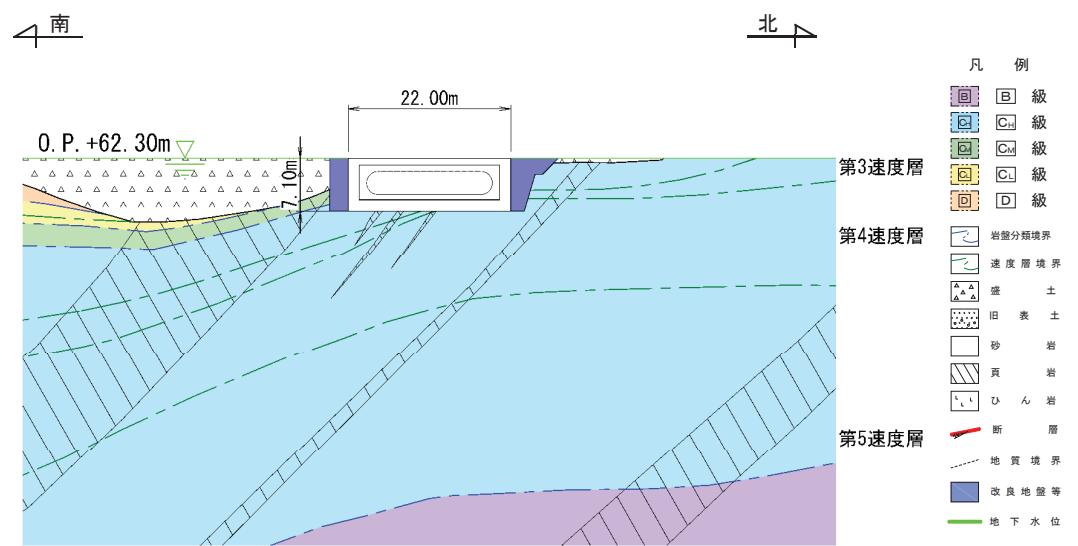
ガスタービン発電設備軽油タンク室地質断面図 (B-B)
